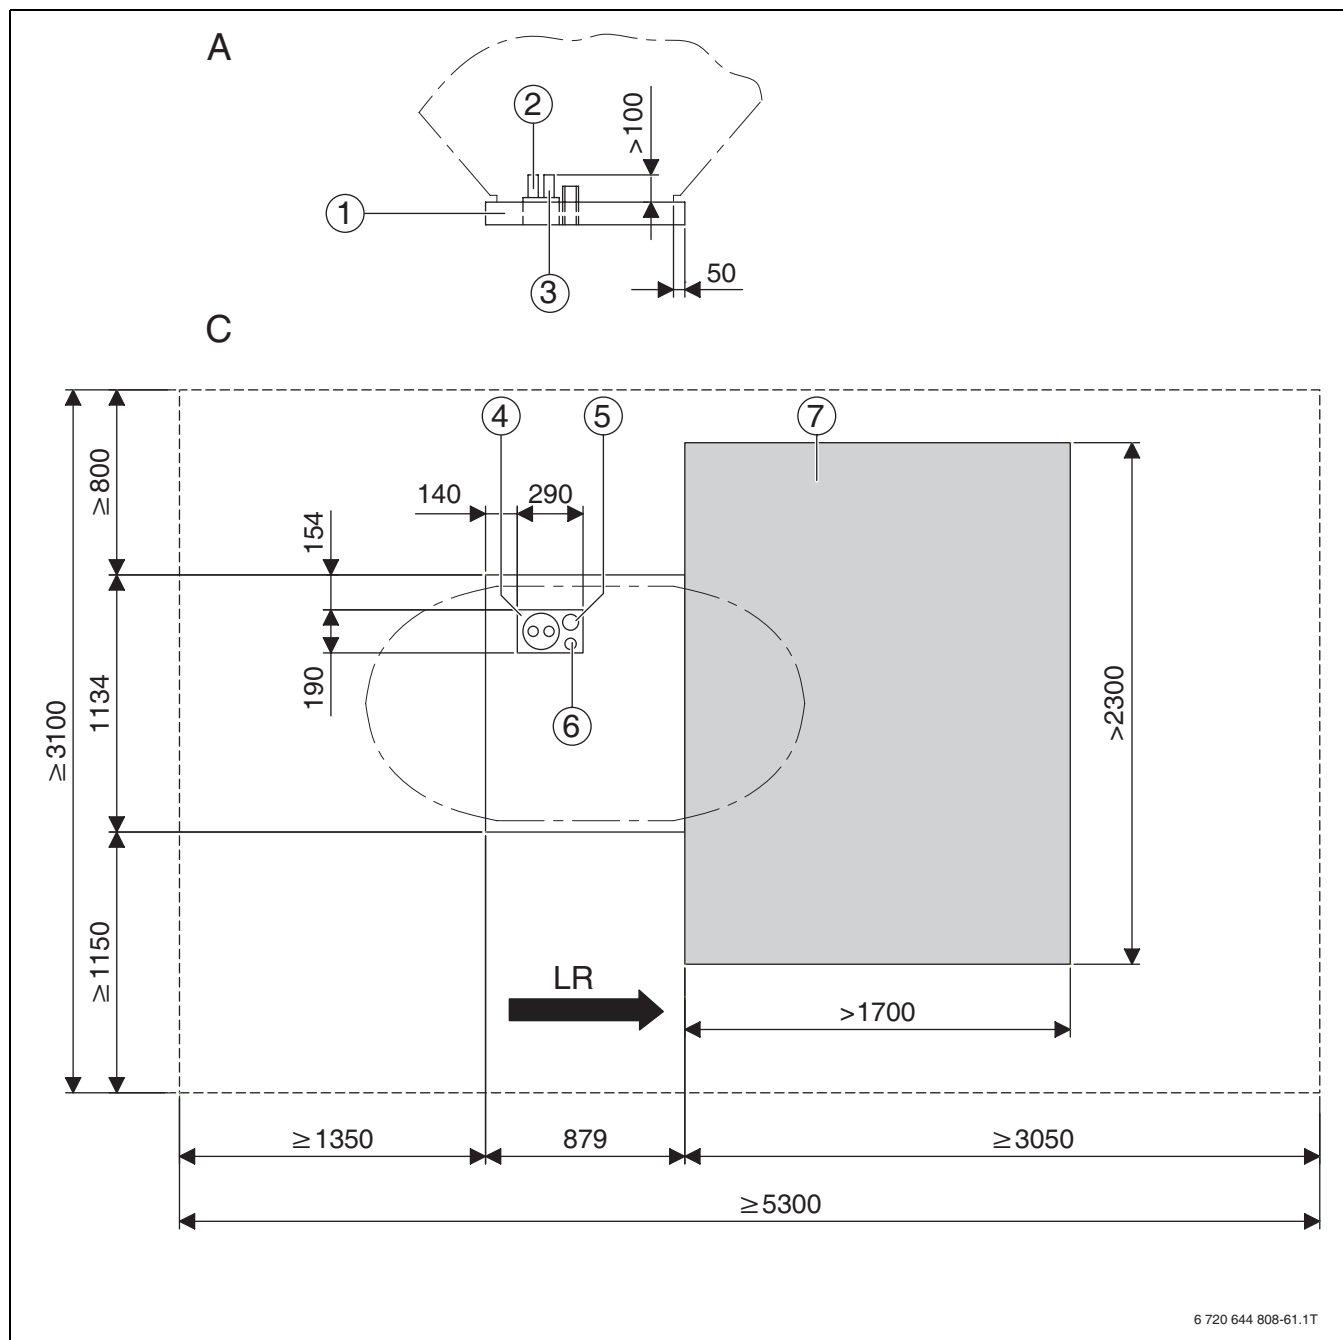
Aufstellungsplan und Mindestabstände Logatherm WPL10 A (Maße in mm)
